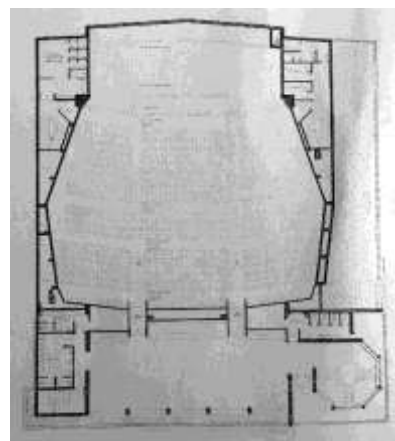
Planta ao nível do piso das entradas, revista *Binário* nº100, p.365
